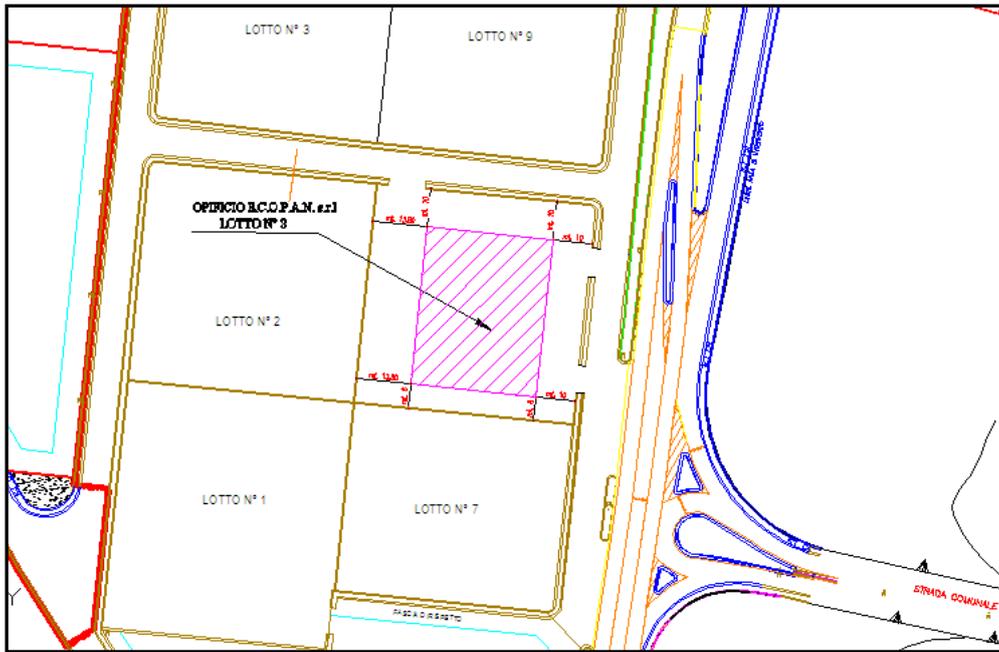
Stralcio Planimetrico dell'area P.I.P.
